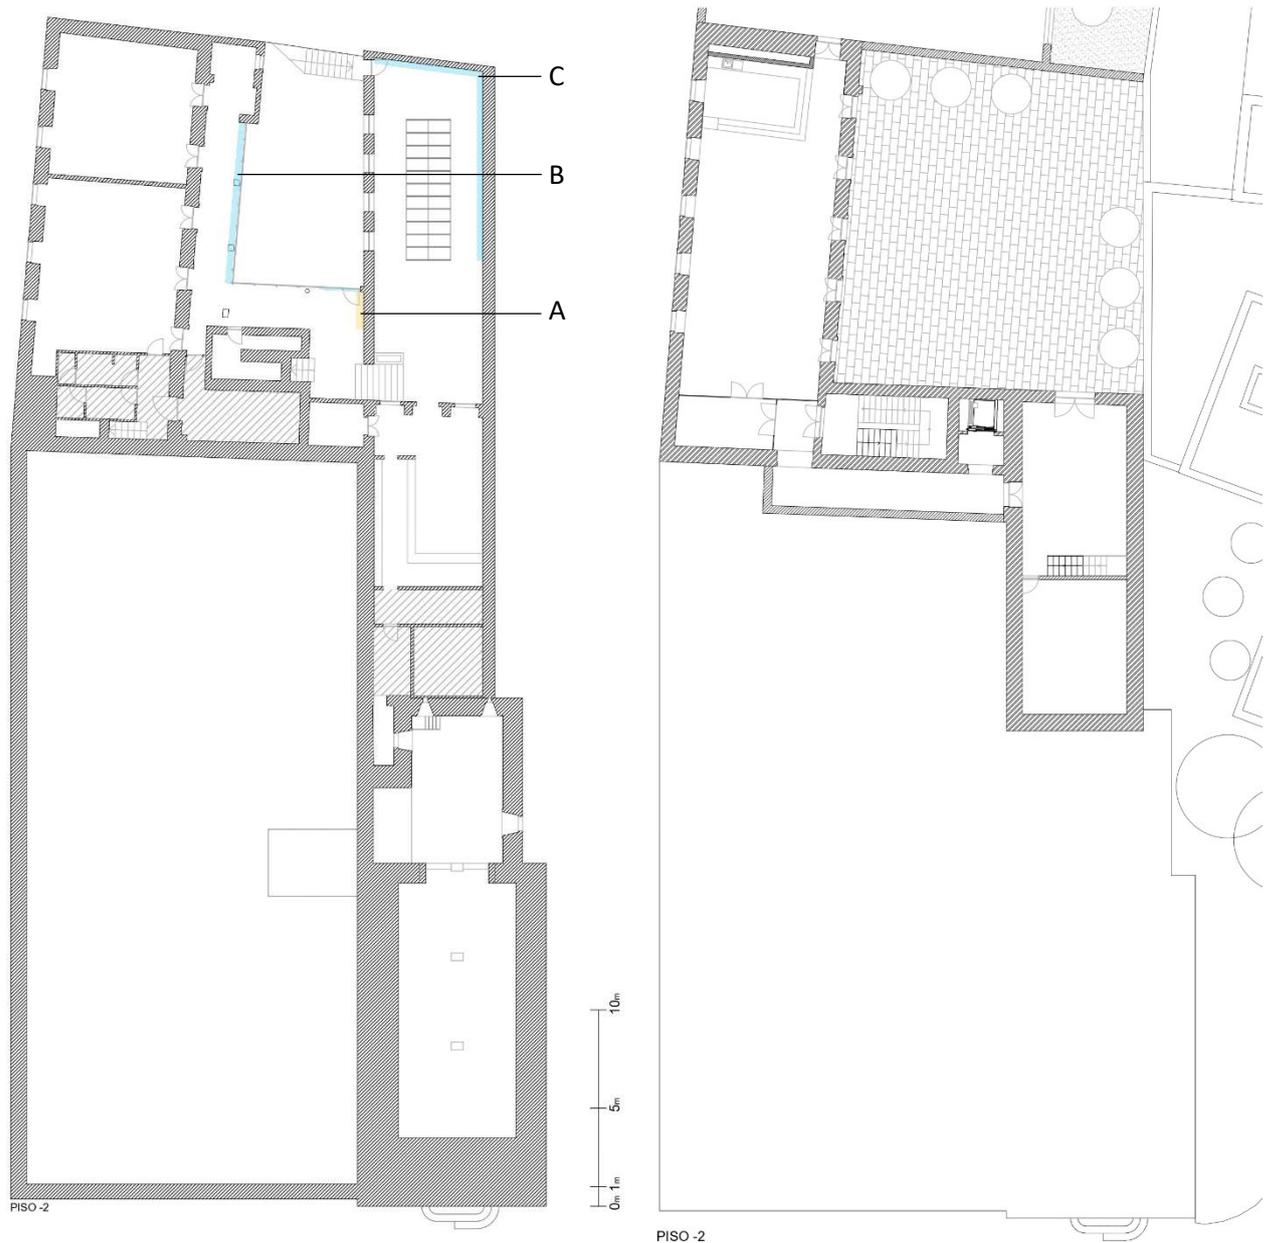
e 88 - Levantamento de patologias piso -2; Planta do piso -2 - Proposta;
